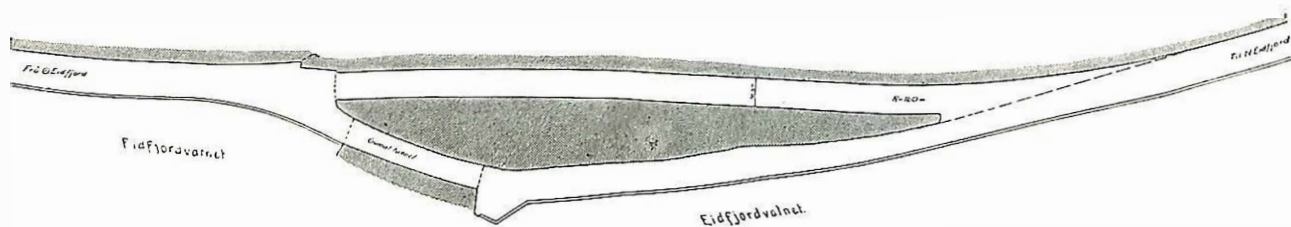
Vegutvidinga på Eidfjordvegen. Grunnriss av den 100 m lange tunnelen.
